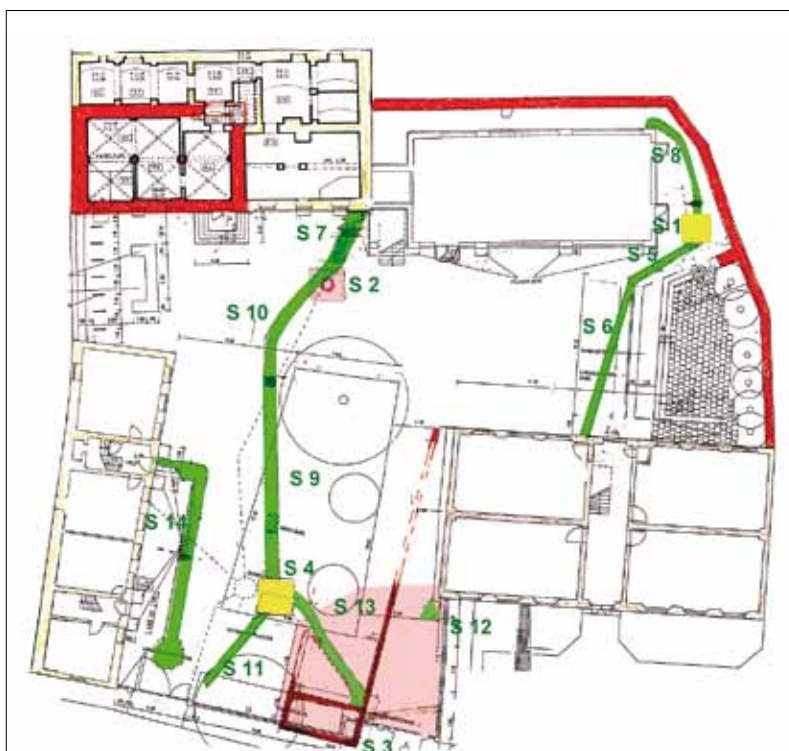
Grundstück. Plan der Tiefbau-Bodeneingriffe (Schnittplan, Schnitte 1–14)
